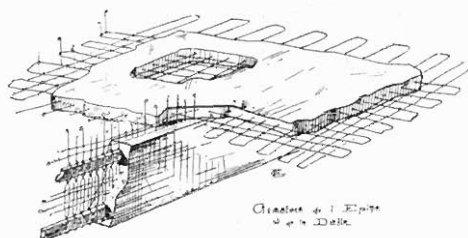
Assemblage d'une épine et d'une dalle (Système P. Cottancin.)
